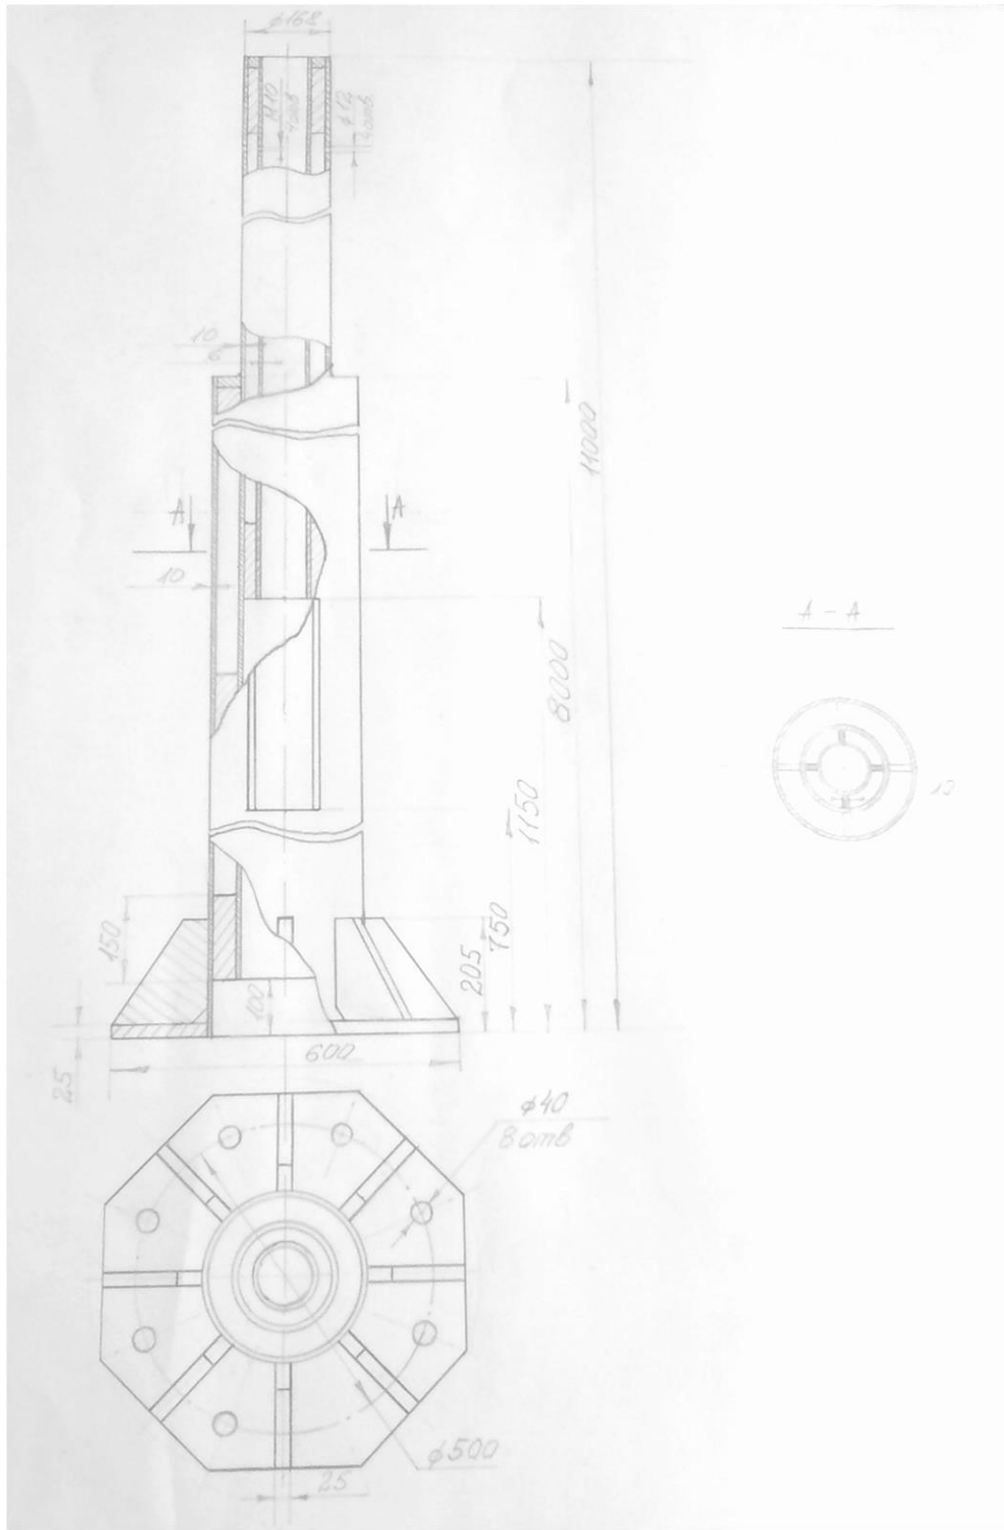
Композитна трехланкова опора типу КТЗ/06
